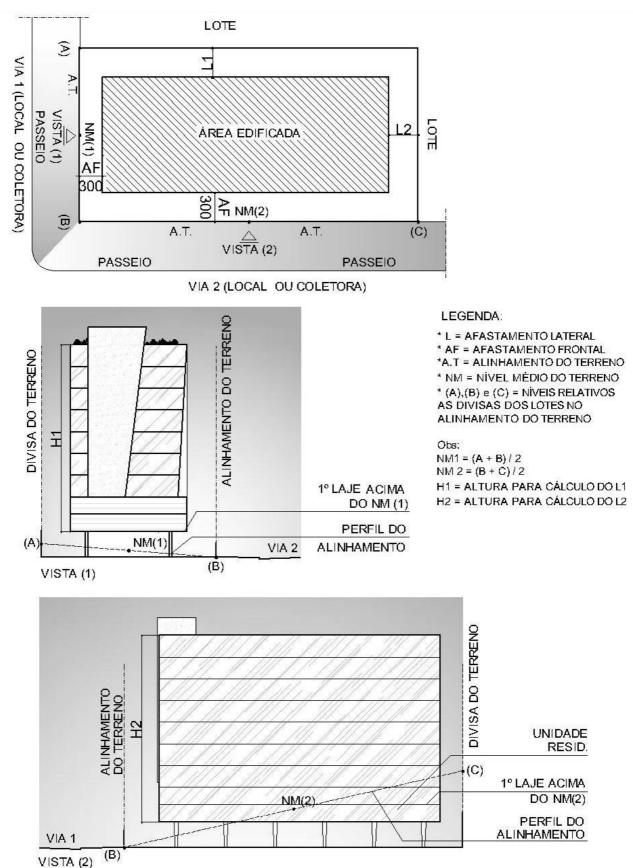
Afastamento lateral ou fundo para edificação implantada em um lote
